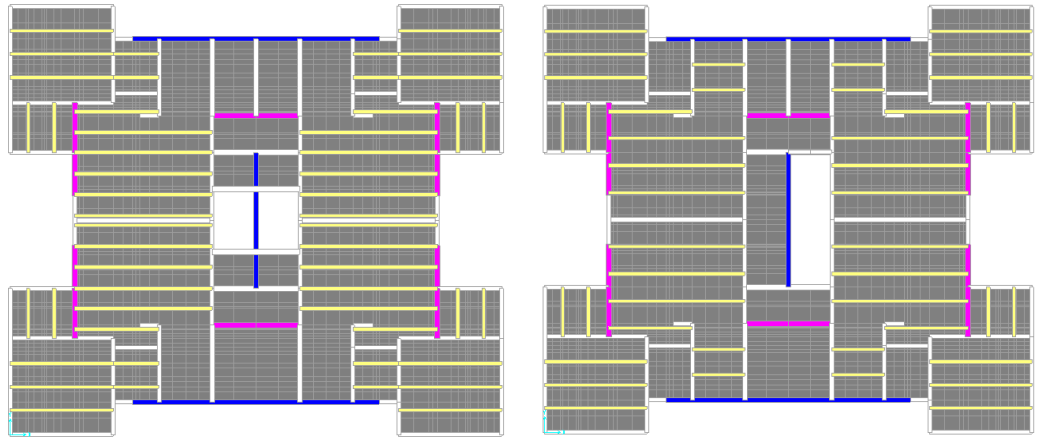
Detalles de las viguetas de la losa de azotea y de la losa tipo
